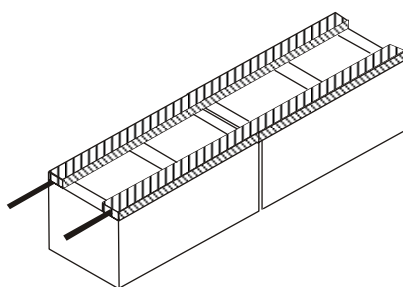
b. Colocación de refuerzos de acero en las juntas
